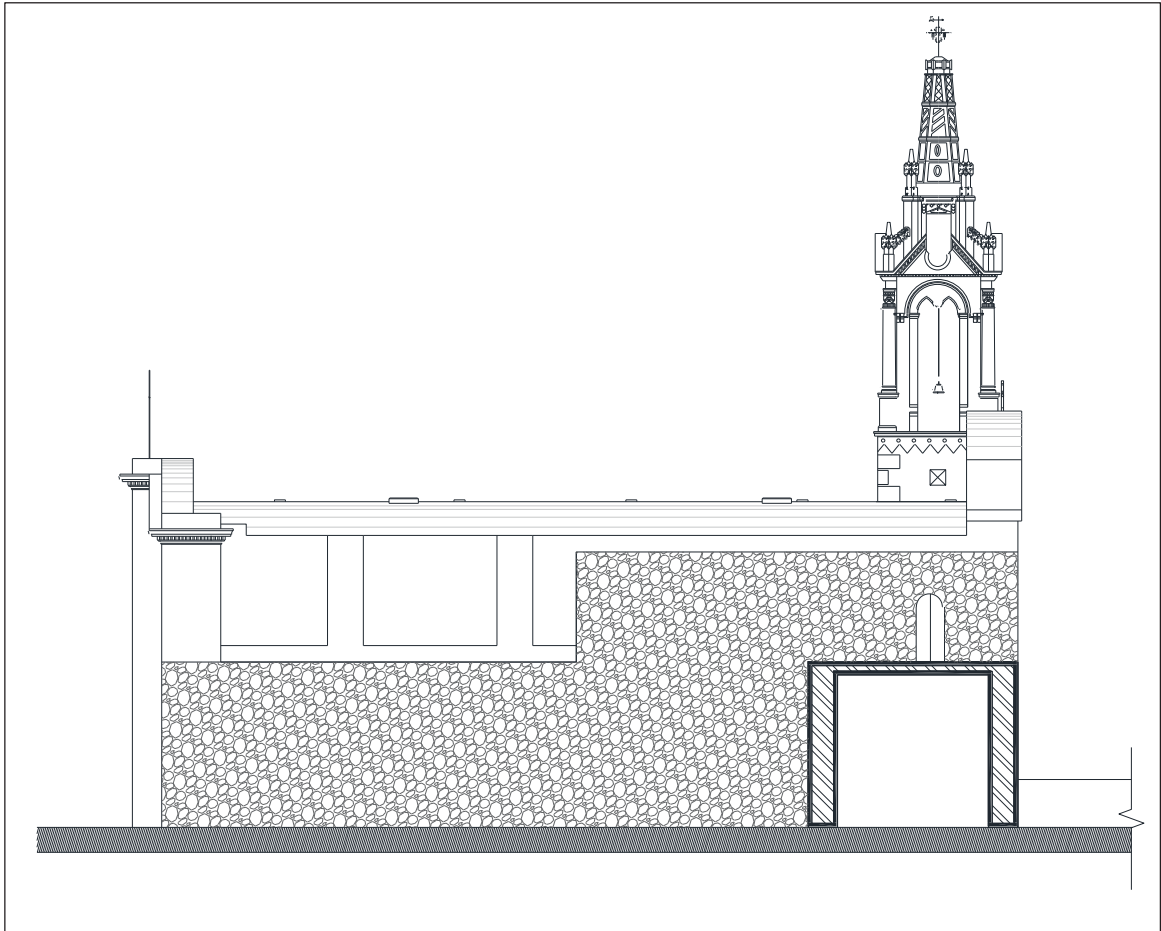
Elevación de la fachada sur de la Capilla, posterior a la destrucción de la Casa Grande.
